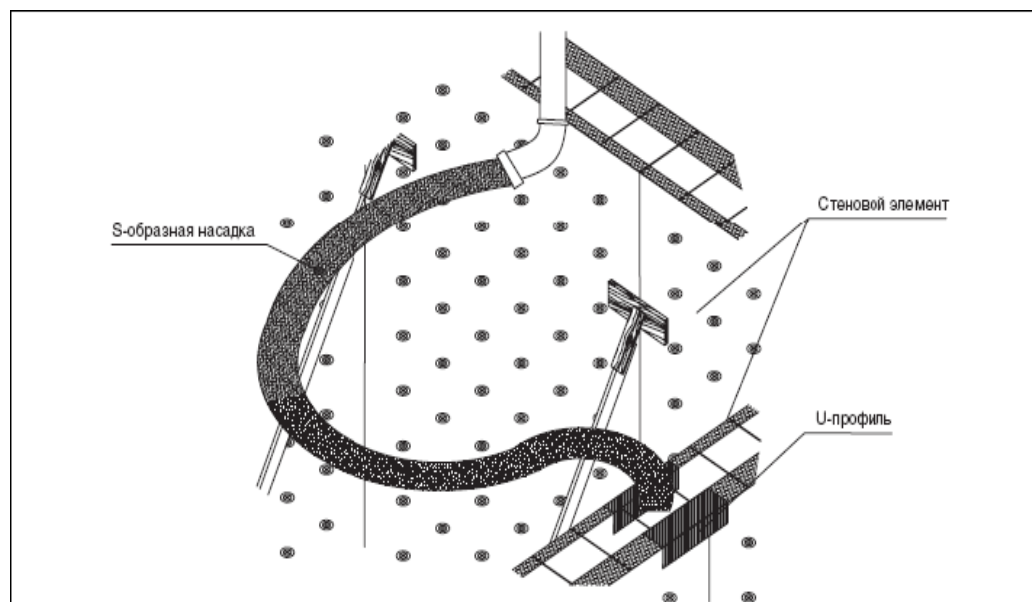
Заполнение бетонной смеси в элемент стеновой опалубки бетонным насосом с использованием S-образной насадки.
